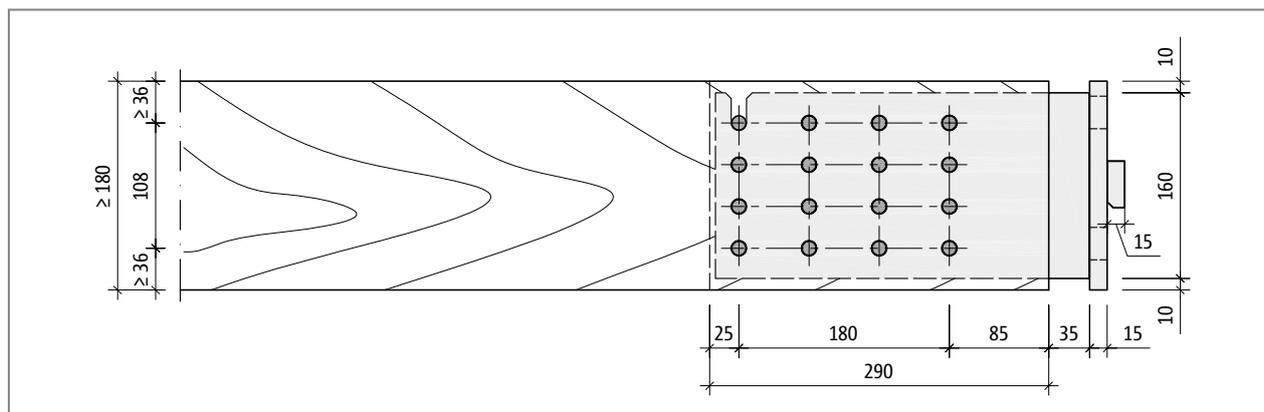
Schöck Isokorb® T Typ SQ mit Stahlschwert: Stahlschwert mit angeschlossenem Holzbalken
